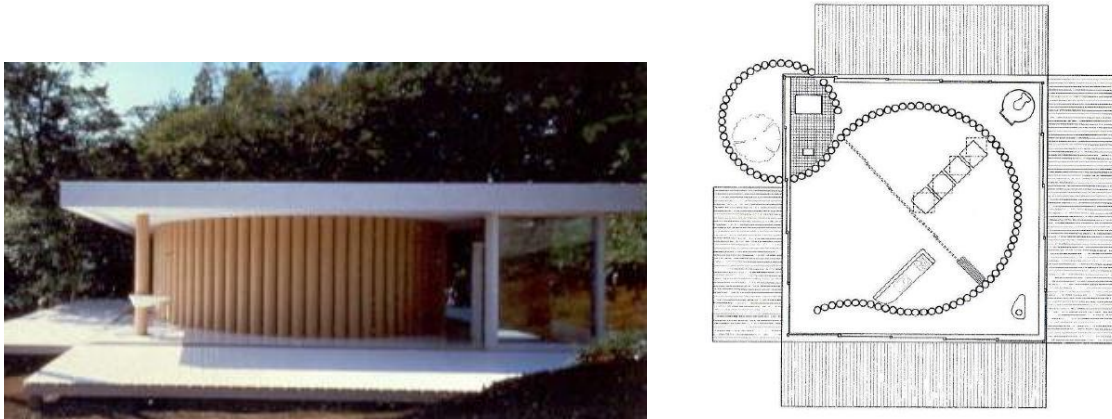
y 40: Izda: Residencia de campo de Shigeru Ban (Designboom, n.d.). Dcha Planta baja de la residencia de Shigeru Ban (Designboom, n.d.) Disponibles en: <https://www.designboom.com/interviews/shigeru-ban-designboom-interview/>
